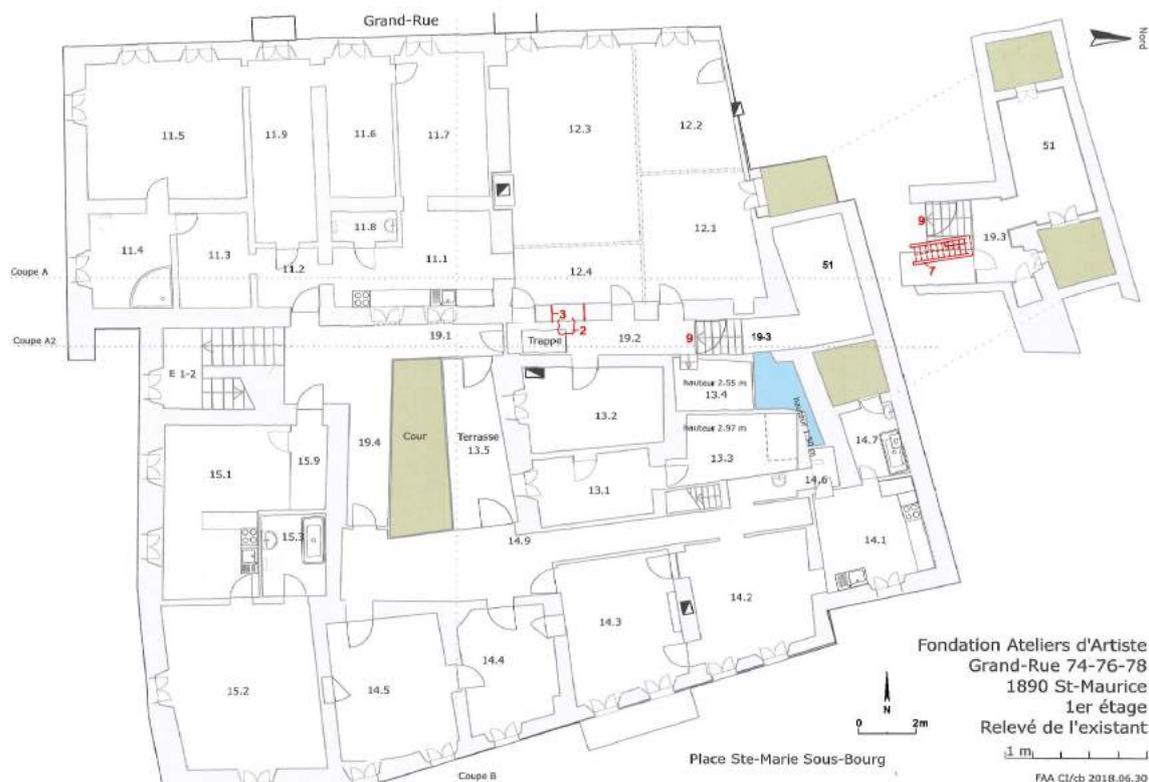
Plan du 1er étage du bâtiment. En rouge, les éléments archéologiques observés sur place. Sur la base du levé effectué par la Fondation Ateliers d'Artiste.
